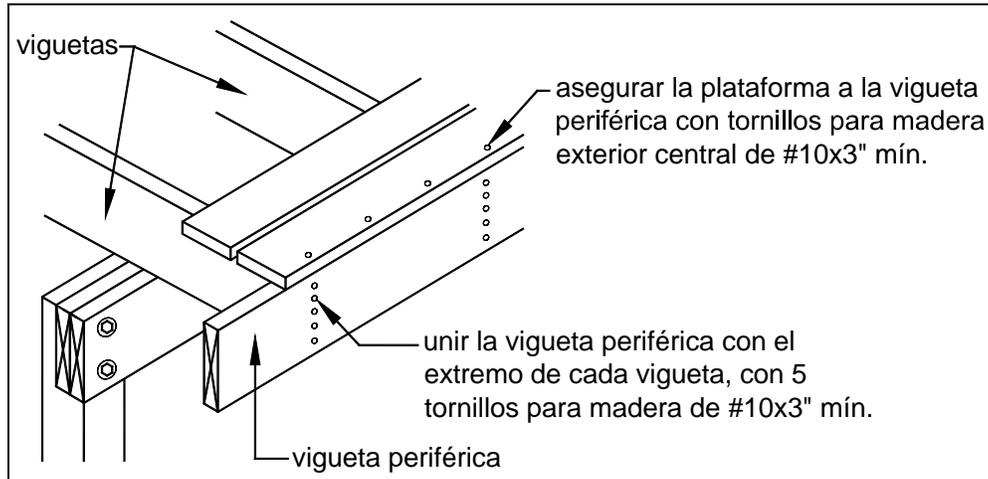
DETALLE SOBRE LA UNIÓN DE VIGUETAS PERIFÉRICAS
